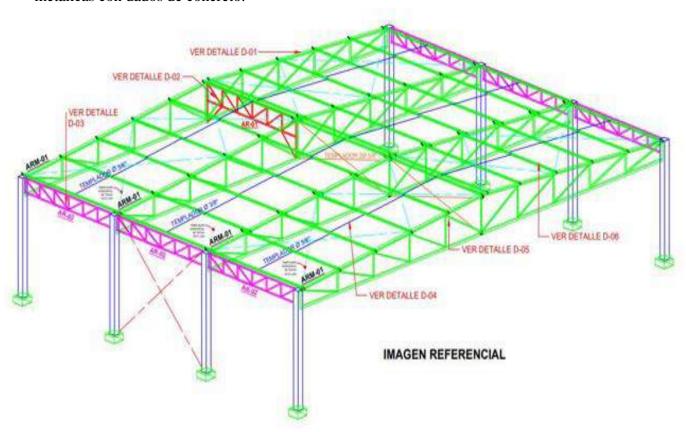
Imagen referencial del sistema constructivo a utilizar.
